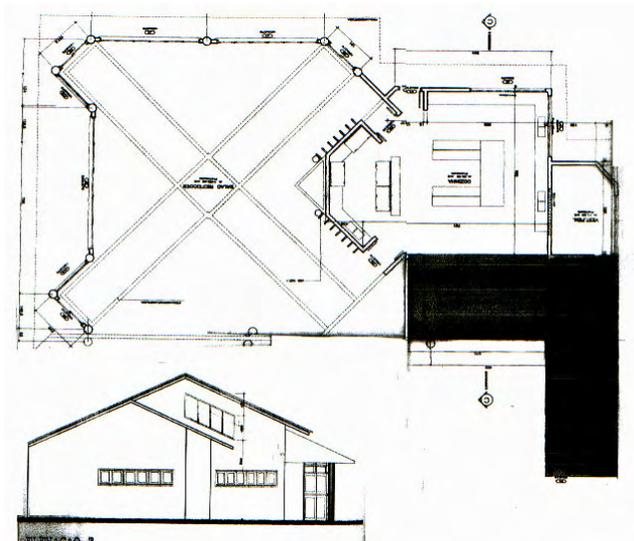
Planta e corte do edifício anexo ao restaurante. Fonte: Arquivo do Hotel Hidrotermal.
